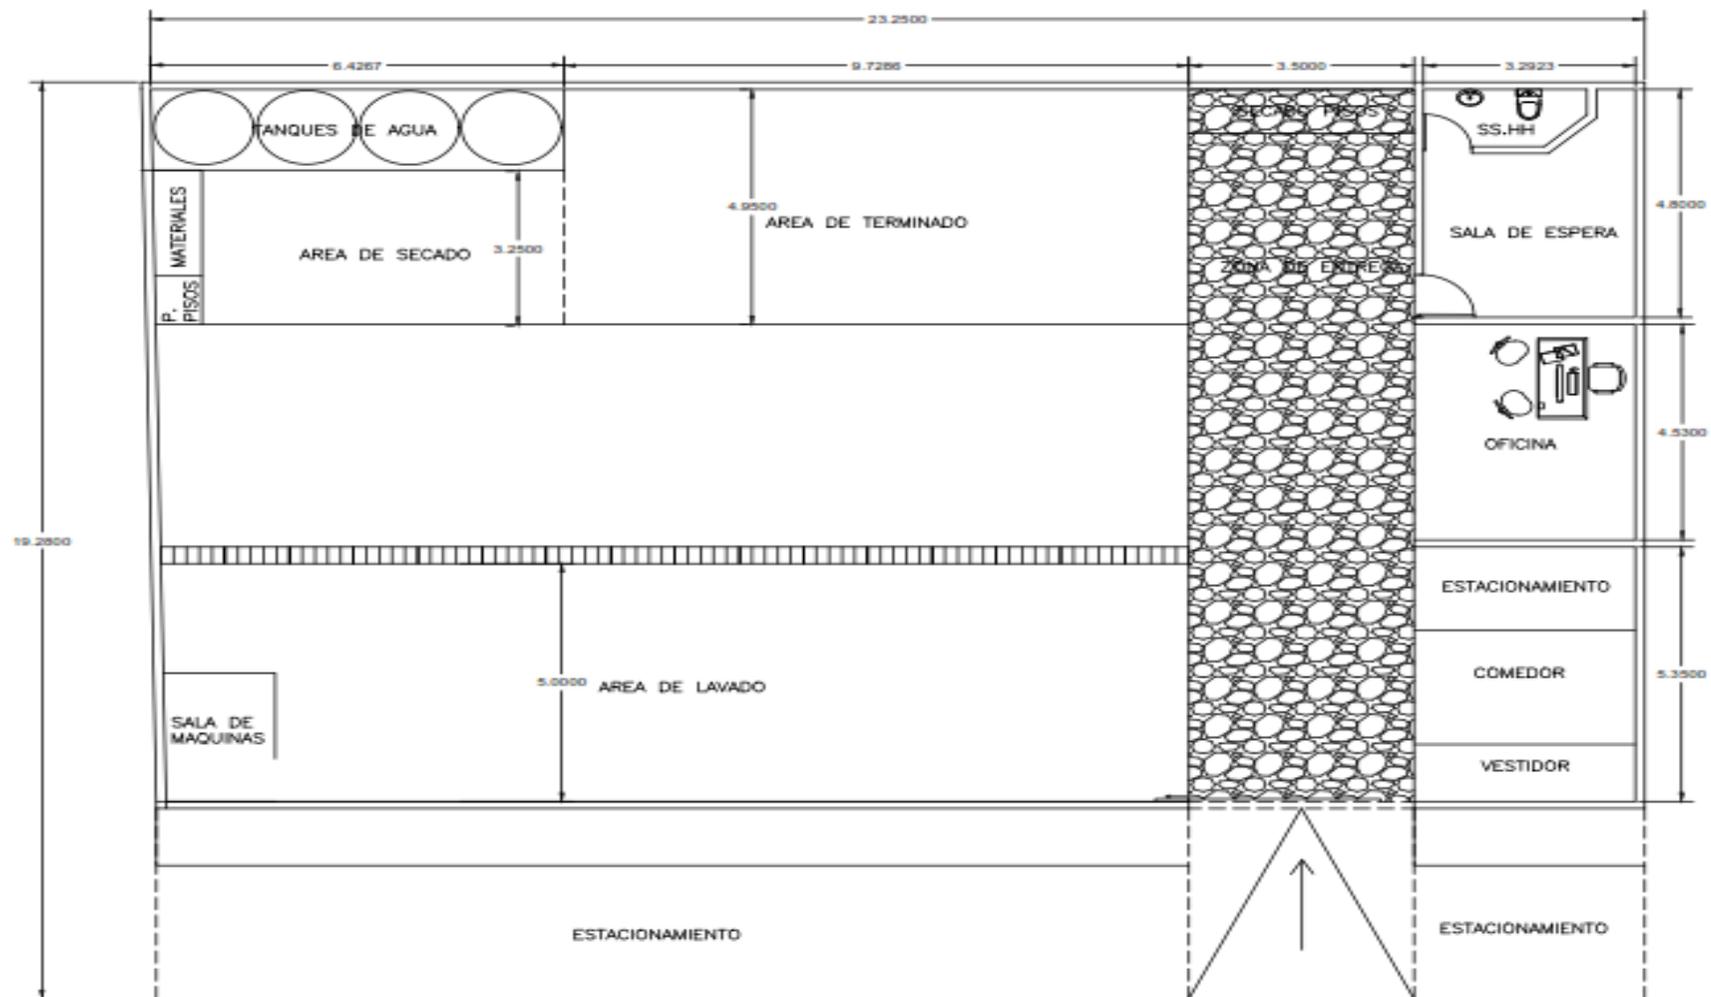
Plano actual de la empresa Platinum Auto Spa S.R.L, 2017
